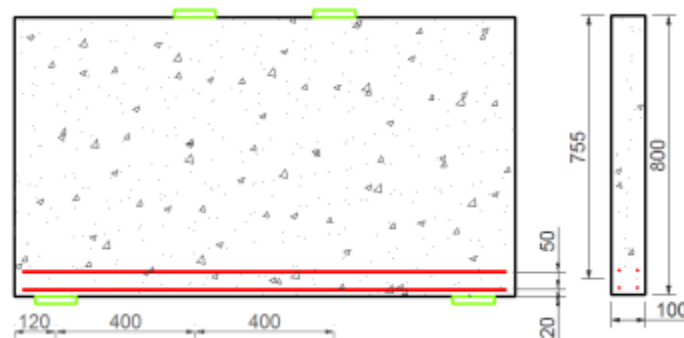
Viga A1 – dimensões em milímetros (mm) – adaptado de Guimarães (1980).
